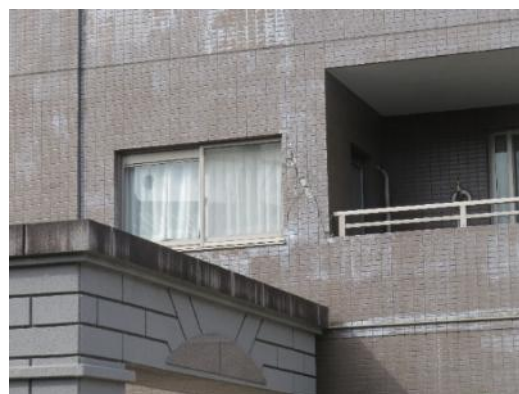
非構造壁のせん断ひび割れ等の被害
